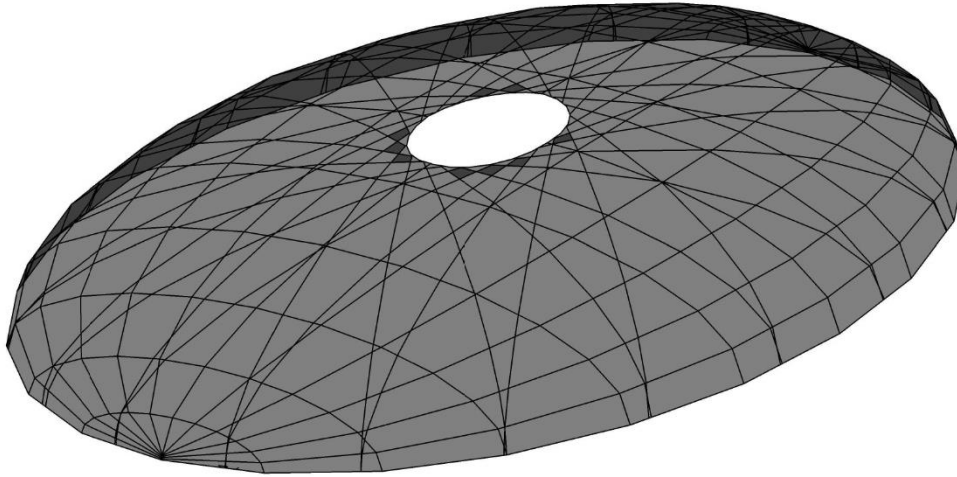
Introducción de la estructura en Autocad. Vista de rayos x
